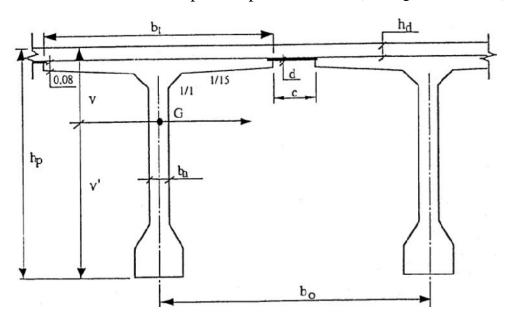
Différents paramètres dimensionnels d'une poutre en BP
